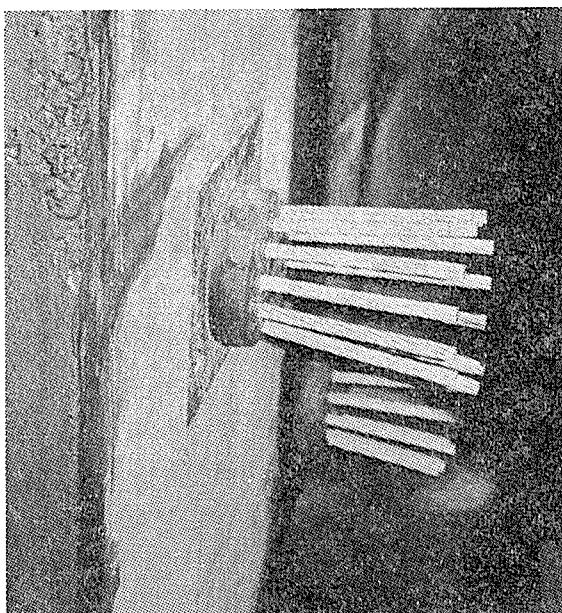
アウトケーブルの配置（桁端：固定アンカー）
